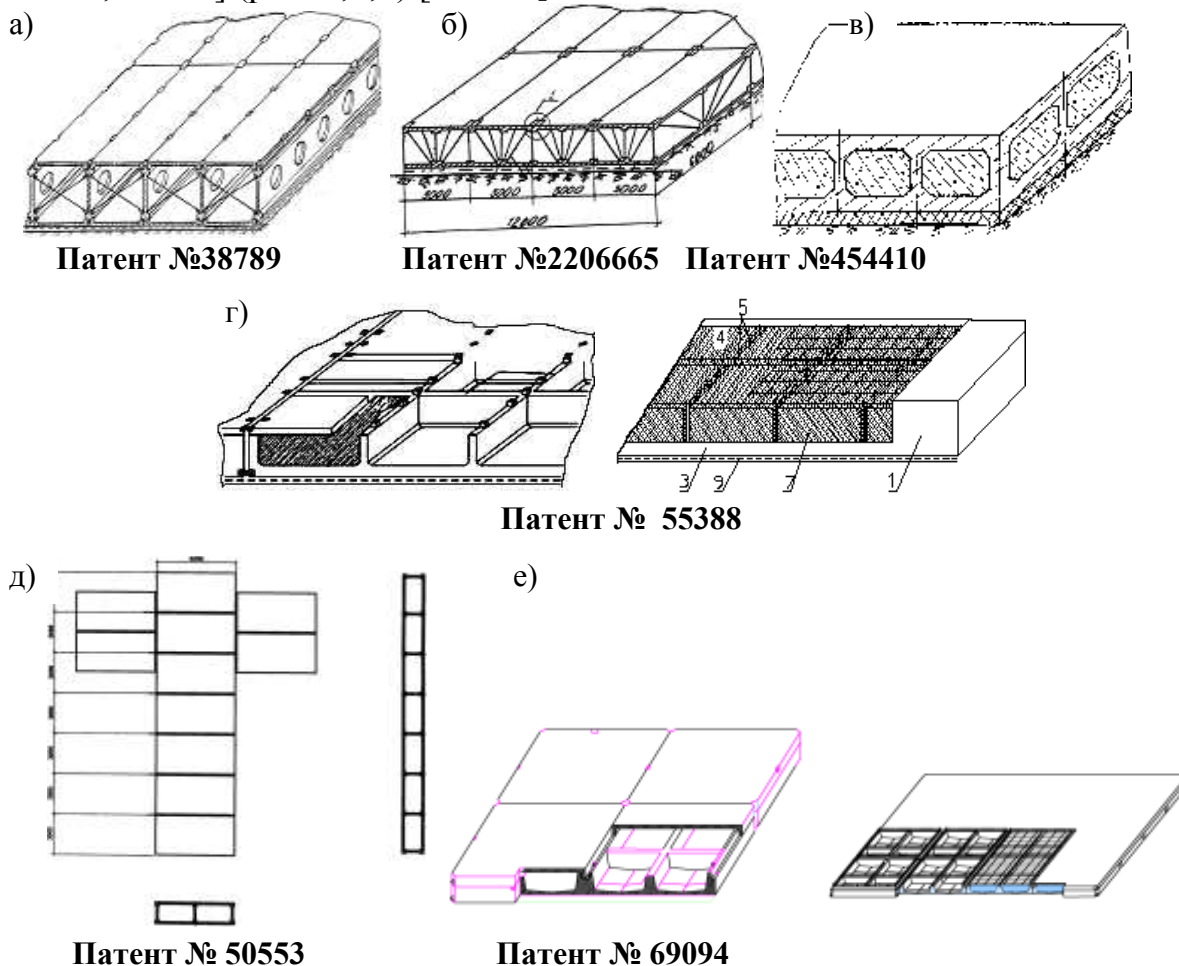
Пространственные фундаментные платформы для строительства на слабых и вечномёрзлых грунтах: а) сборная железобетонная платформа (патент №38789); б) сборная железобетонная фундаментная платформа (патент №2206665); в) монолитная фундаментная платформа (патент №454410); г) сборный и монолитный варианты (патент № 55388); д) пространственная фундаментная платформа под агрегаты с динамической нагрузкой (патент № 50553); е) пространственная железобетонная в сборном и сборно-монолитном вариантах патент № 69094)
